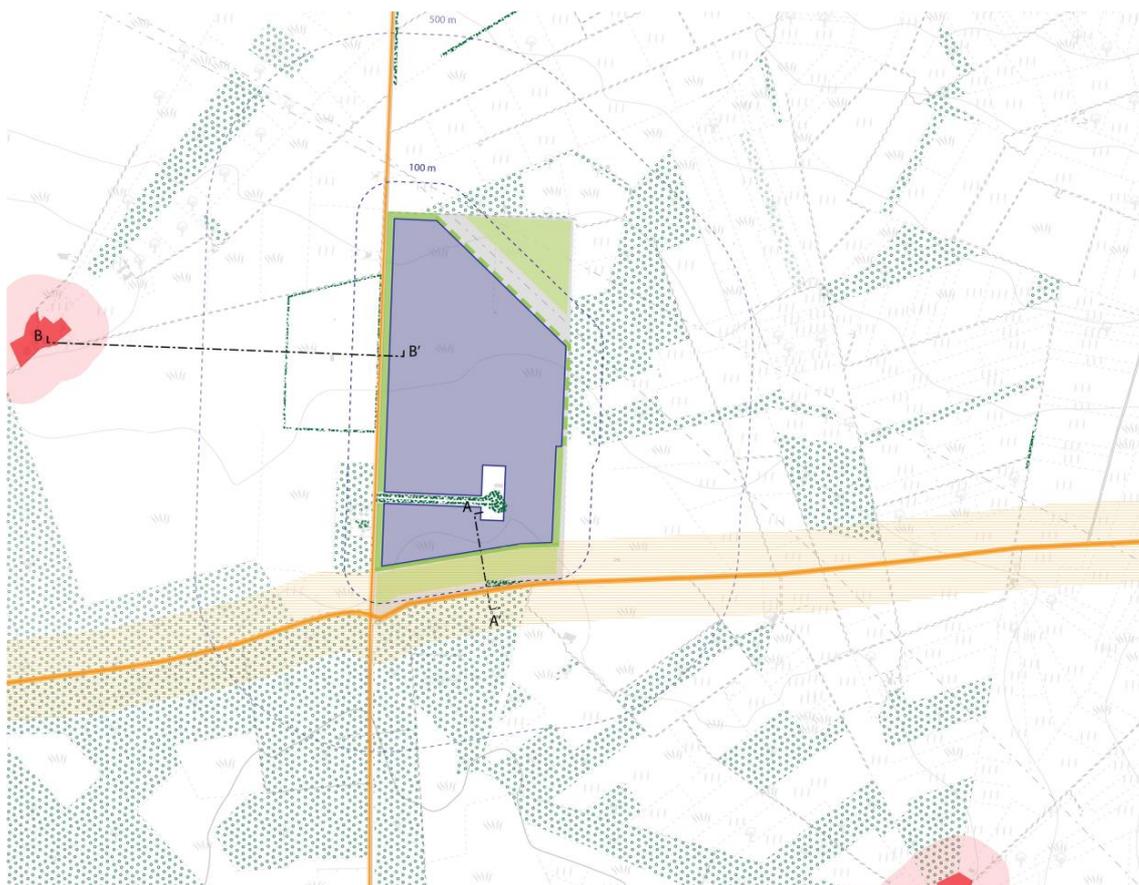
Planimetria di individuazione delle fasce di mitigazione
